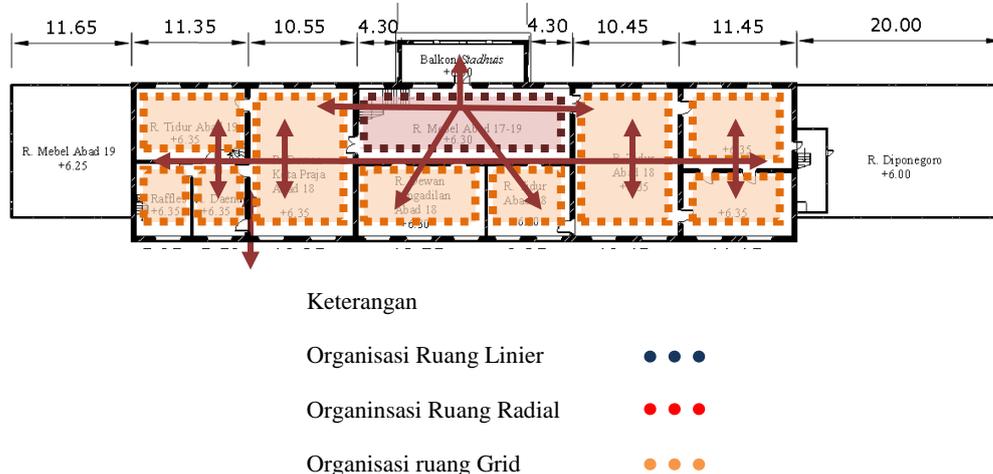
Organisasi ruang pada lantai 1 bangunan Museum Fatahillah
